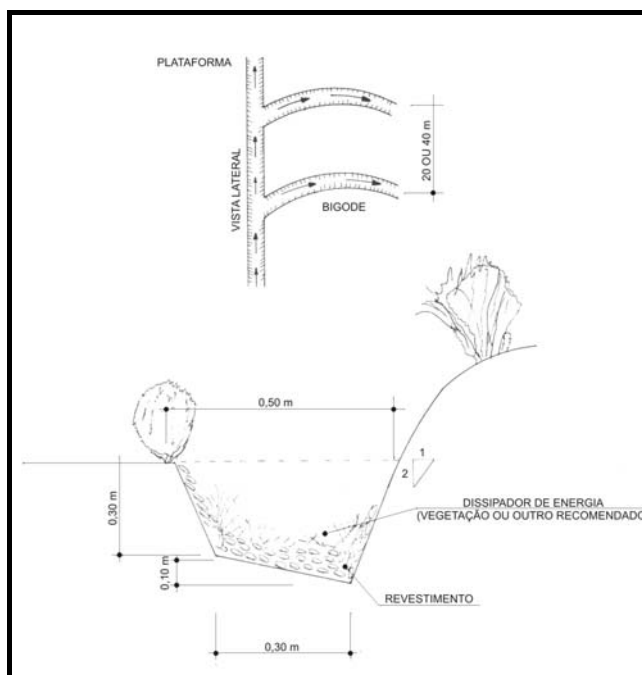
Modelo para construção dos bigodes, ou sangradouros
